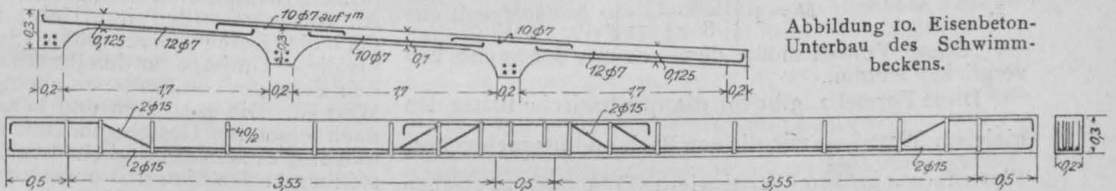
Eisenbeton-Unterbau des Schwimmbeckens.
